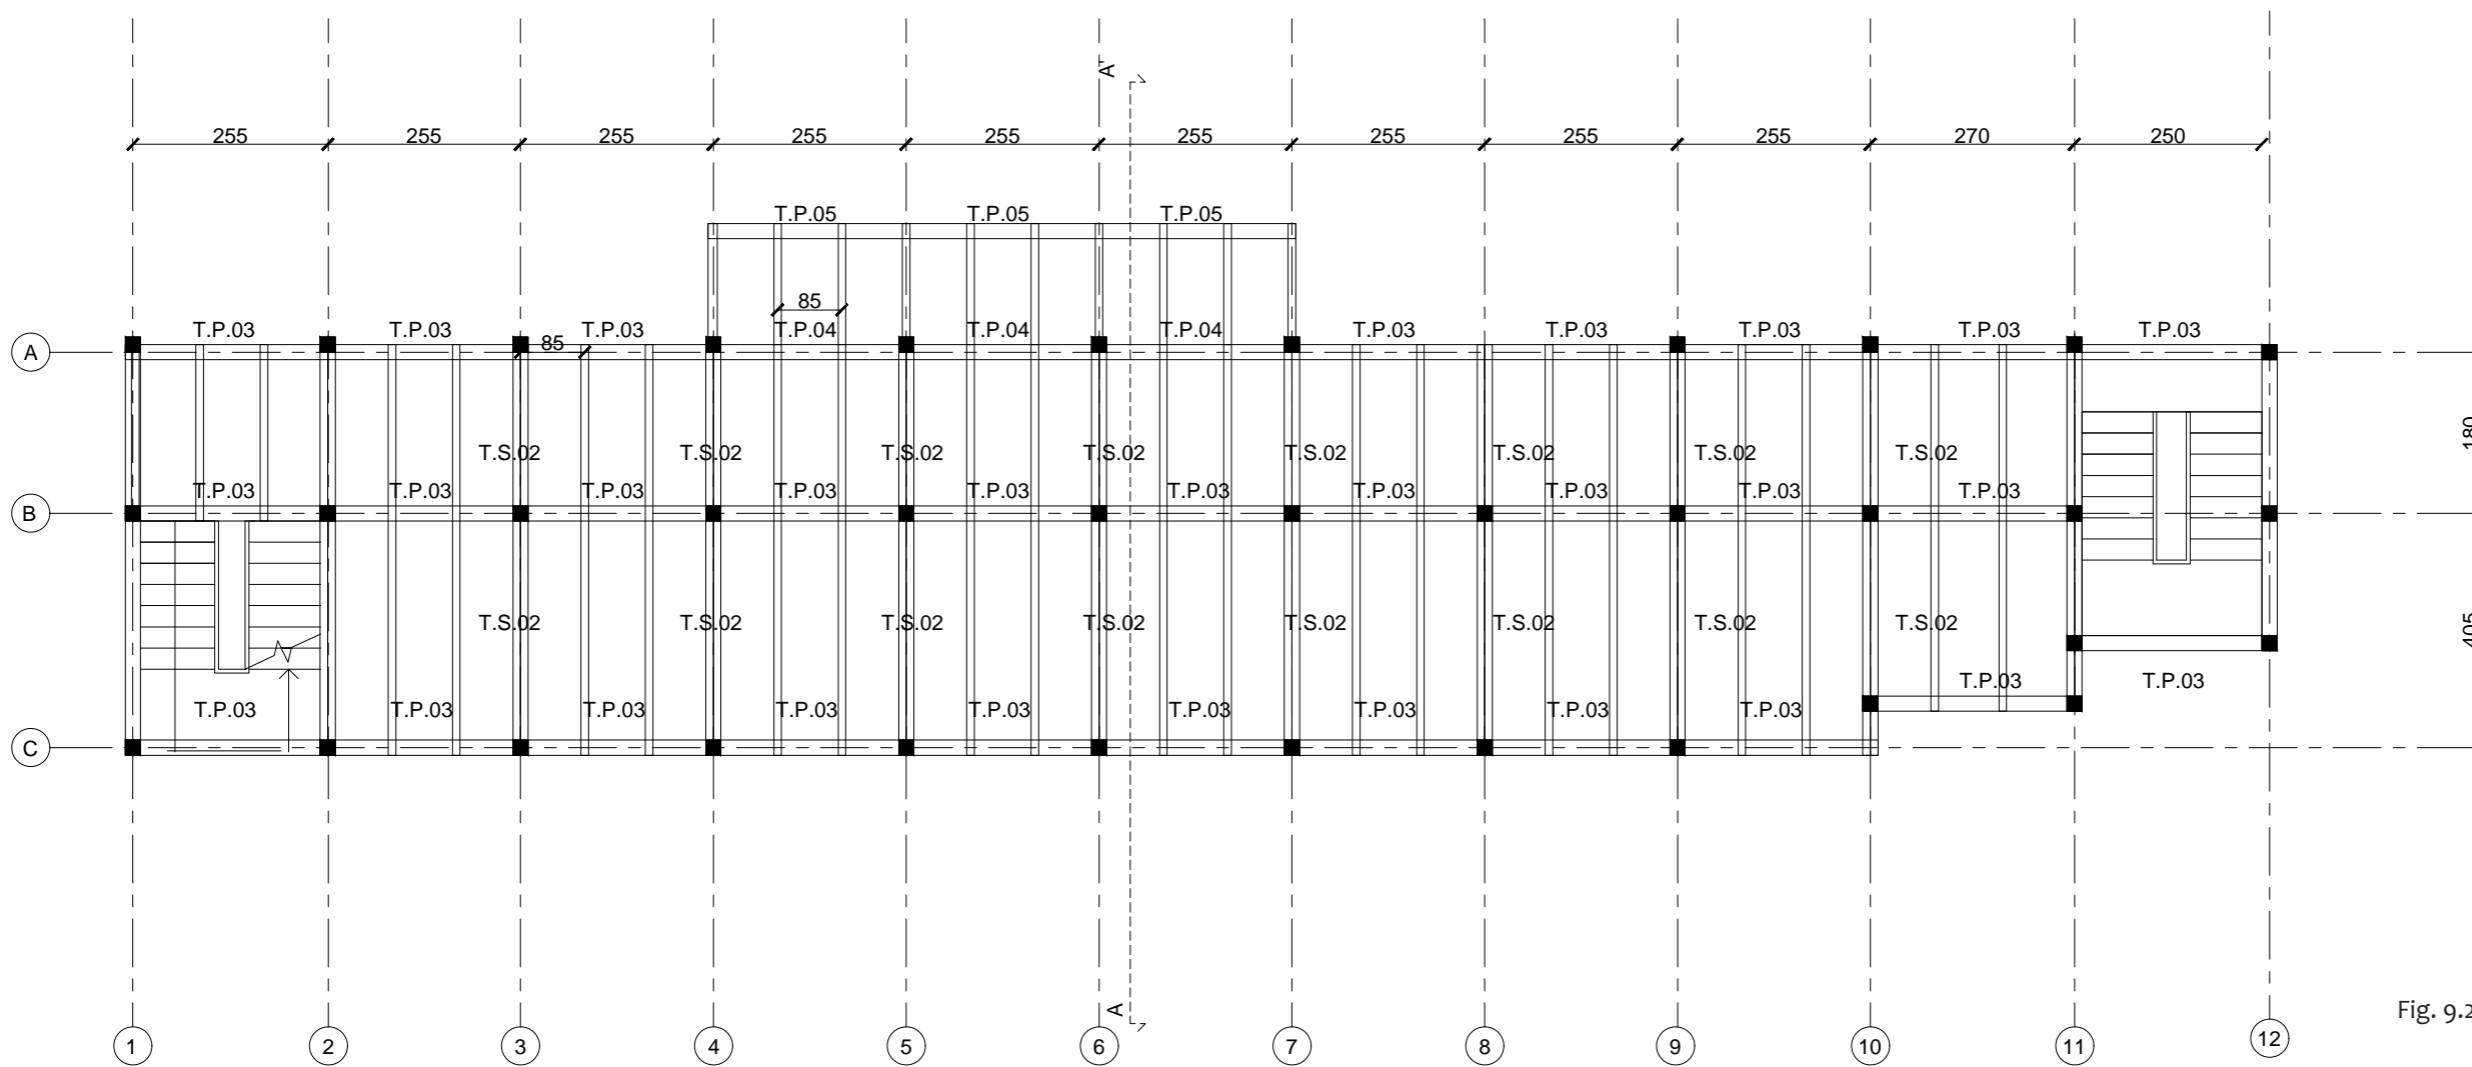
Pianta solaio piano secondo scala 1:100.
